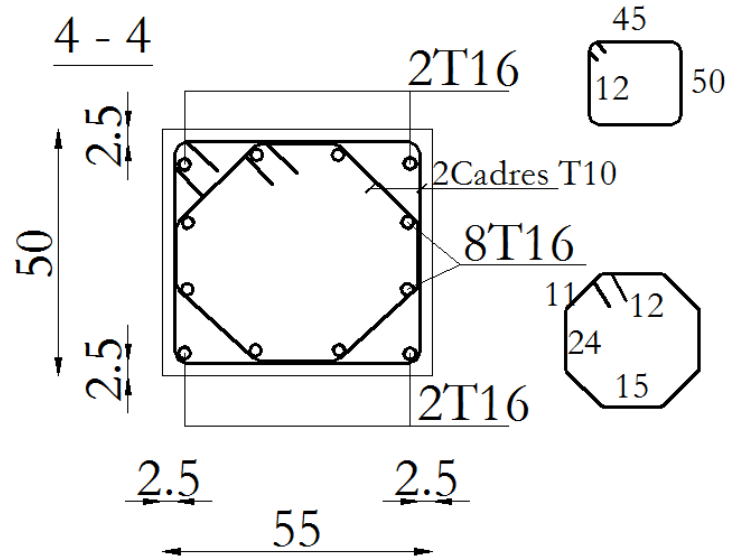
Ferrailage des poteaux 4<sup>ème</sup> et 5<sup>ème</sup> étage
